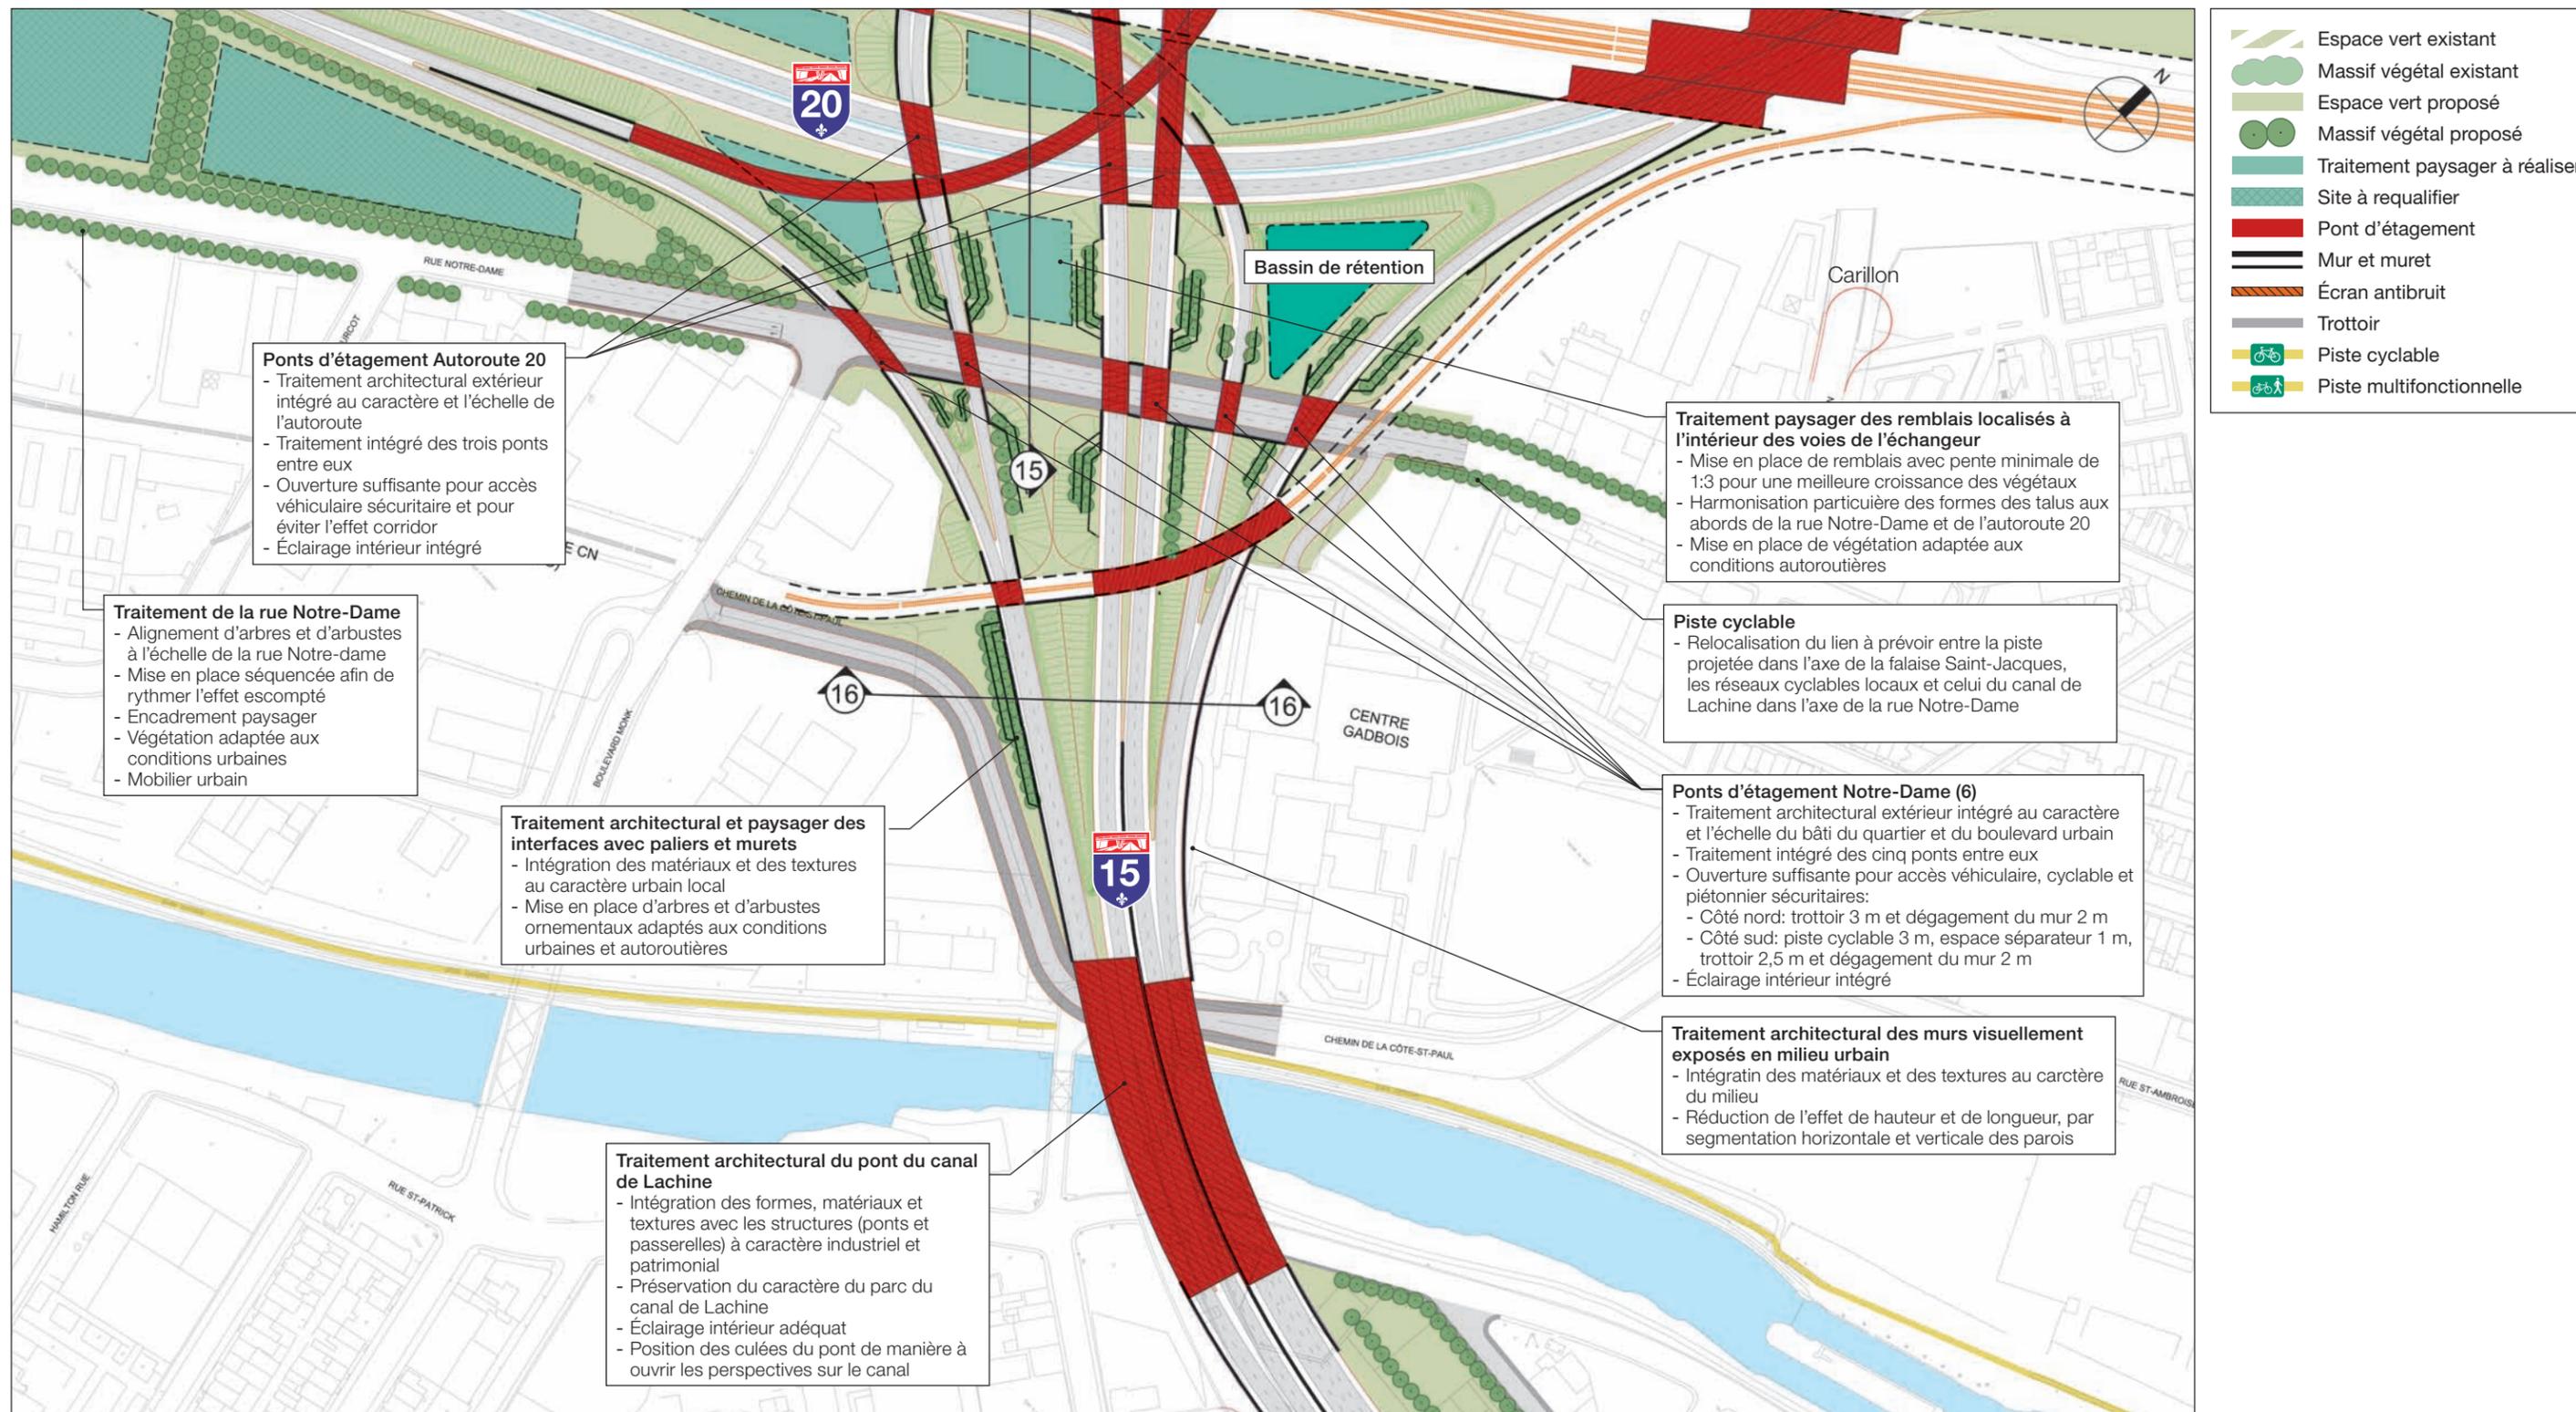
SEGMENT 14, VOIES ET BRETELLES SUD DE L'ÉCHANGEUR
